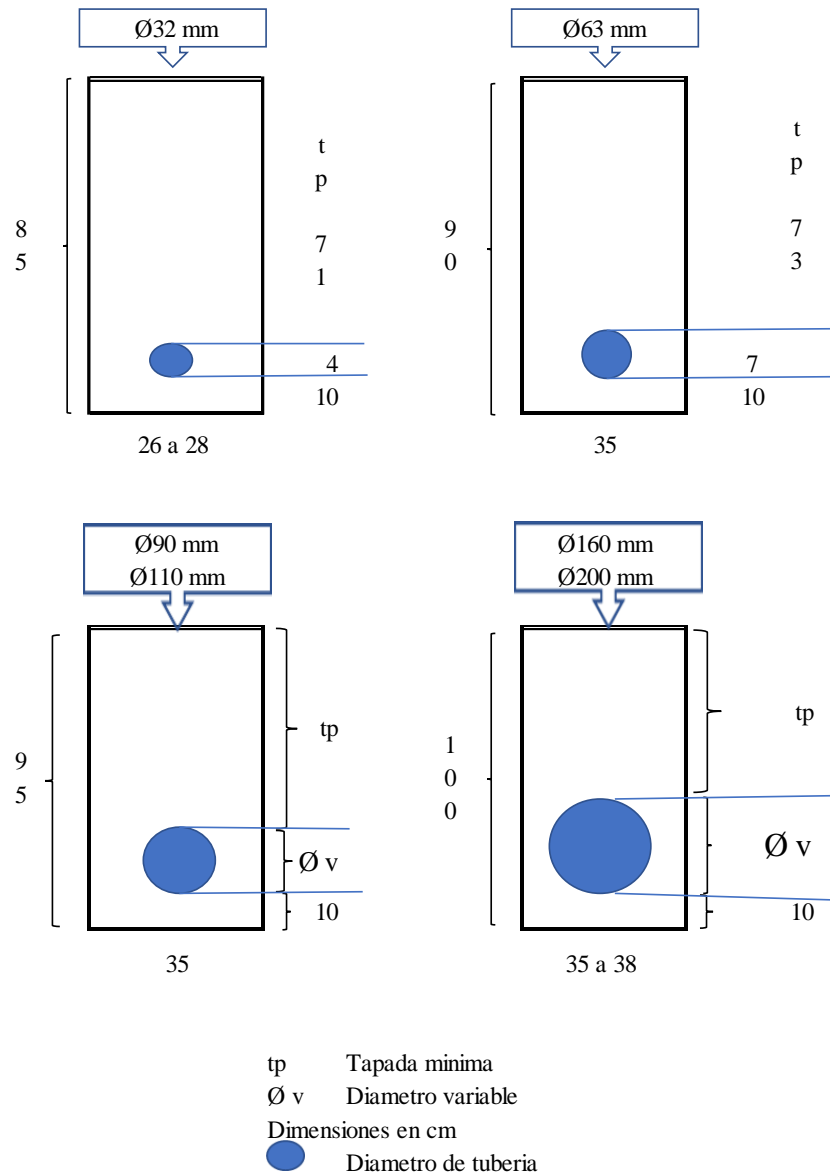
Secciones de zanja para cada tipo de tubería a instalar.
